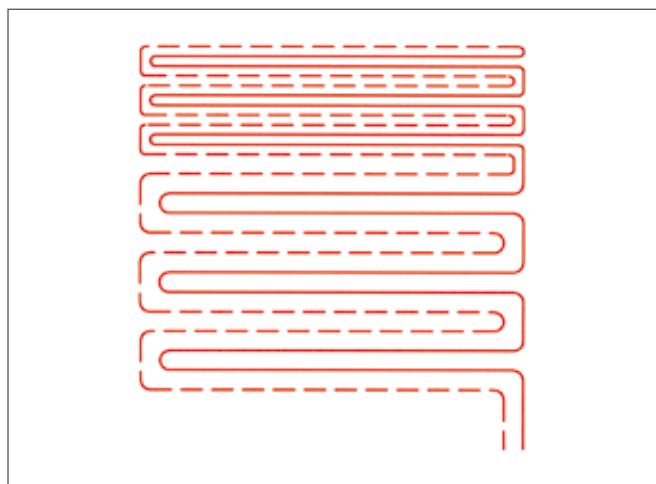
Schema de pozare „meandă dublă” cu zonă marginală de țevi dese integrată
